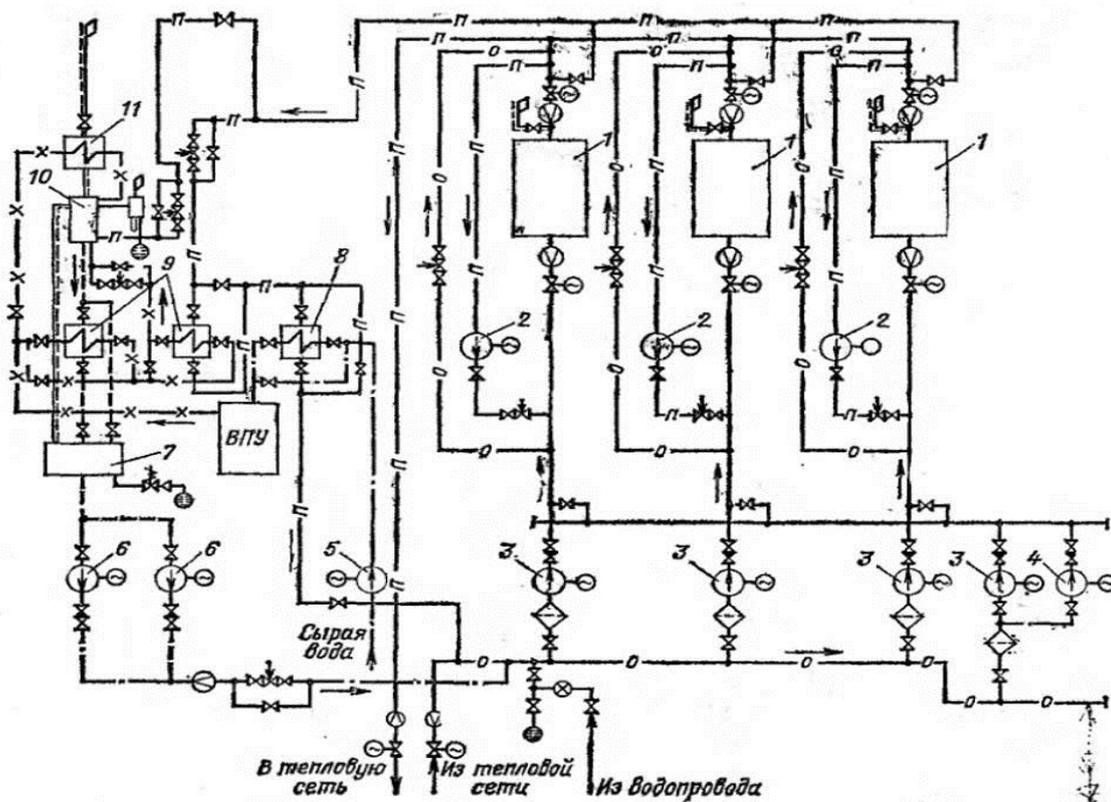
Развернутые тепловые схемы котельных с водогрейными котлами для закрытых систем теплоснабжения.
